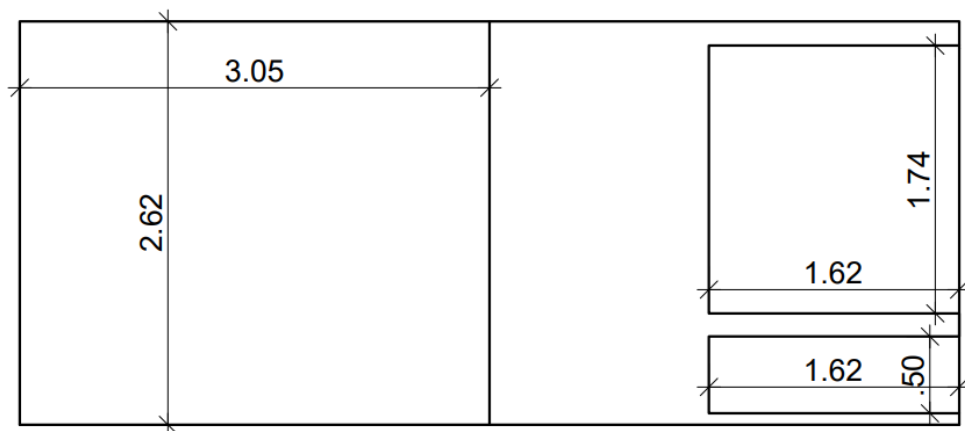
Medidas da escada, poço do elevador e *shaft* para os cálculos das áreas do pavimento térreo.
